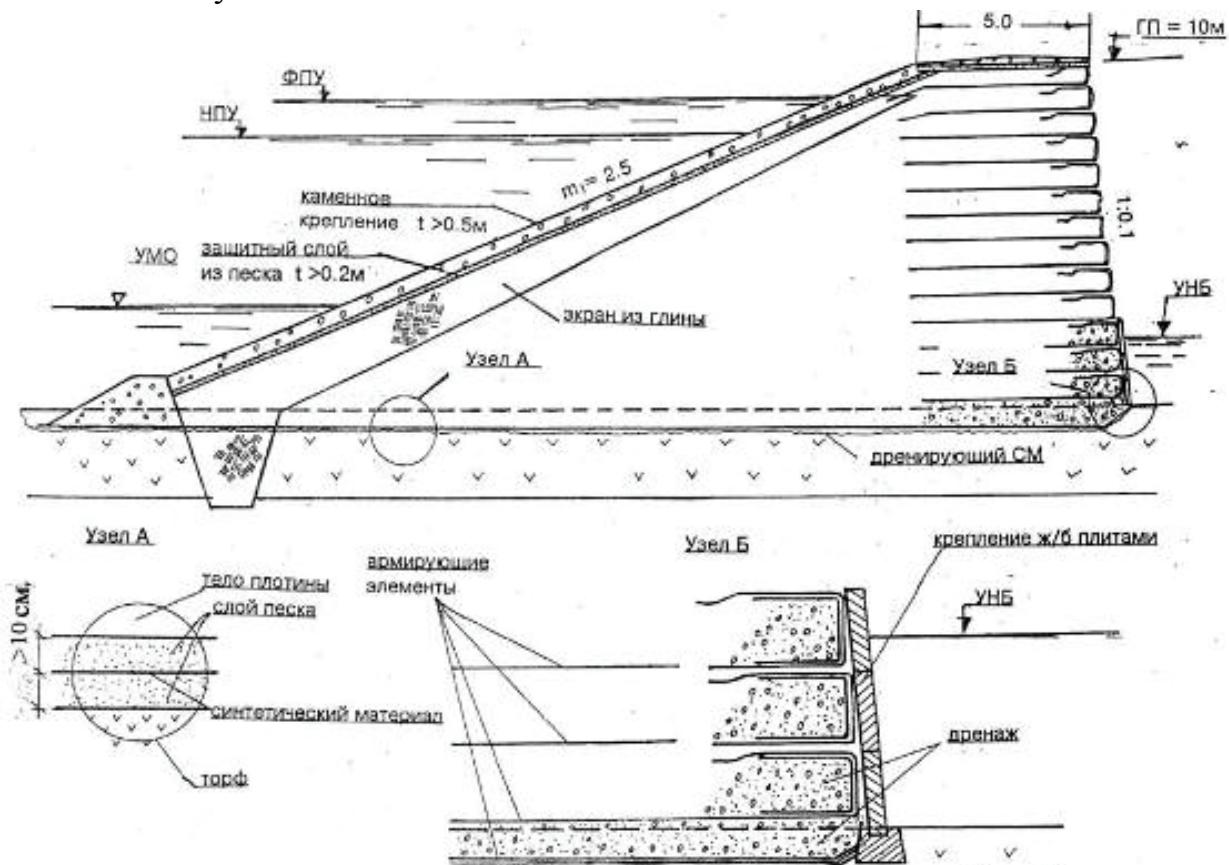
Пример земляной плотины из армированного грунта высотой до 10 м [34]
